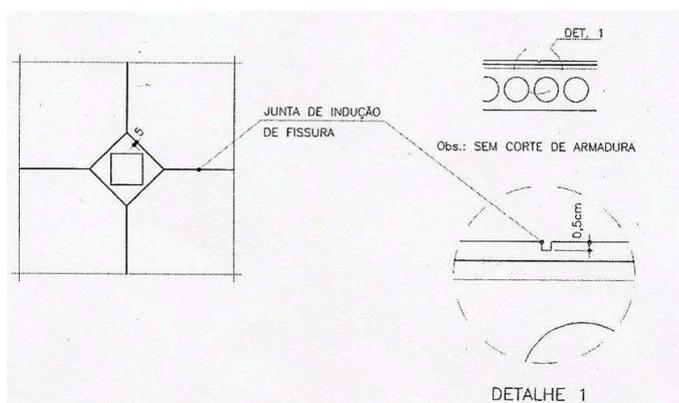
Detalhe de junta de indução de fissuras sem corte de armadura realizado em panos de lajes muito grandes (MELO, 2004)
